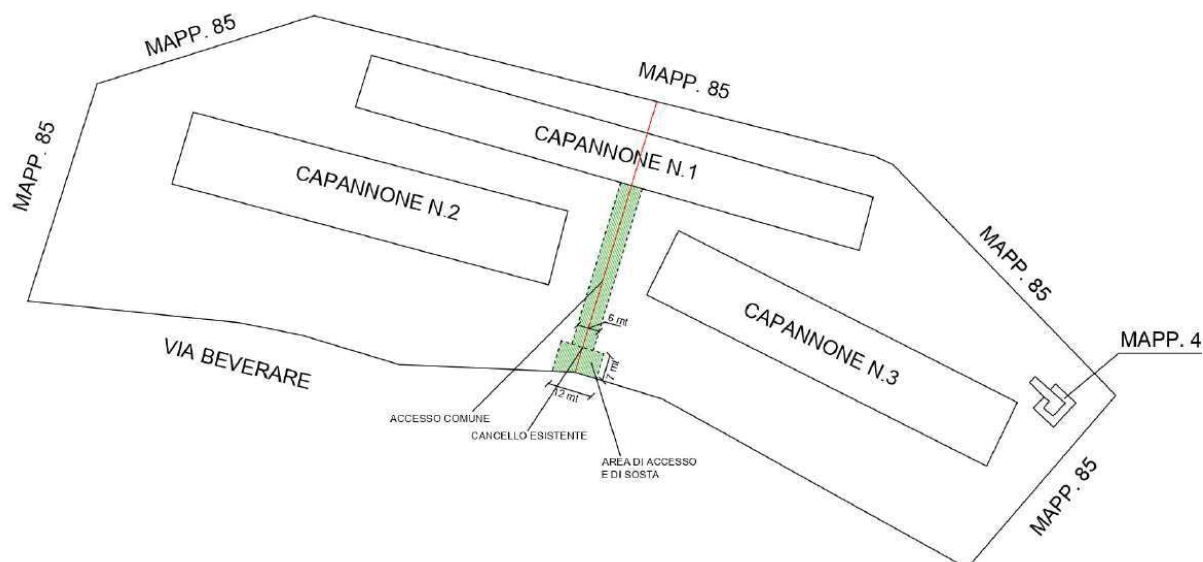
variante alla divisione del lotto 2 proposta dalla CTP Sorato
